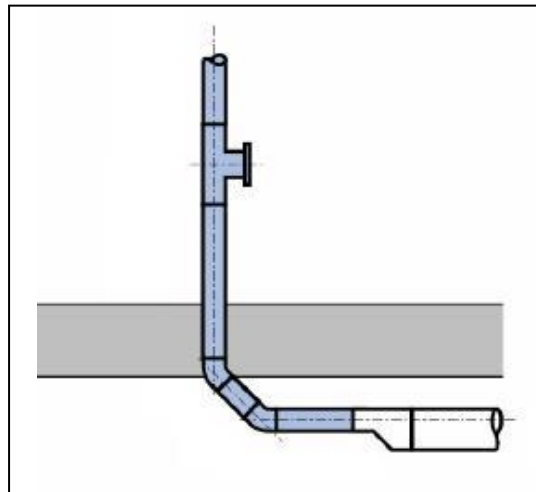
Entrada em sistema gravítico depois do atravessamento da laje de pavimento[22]
